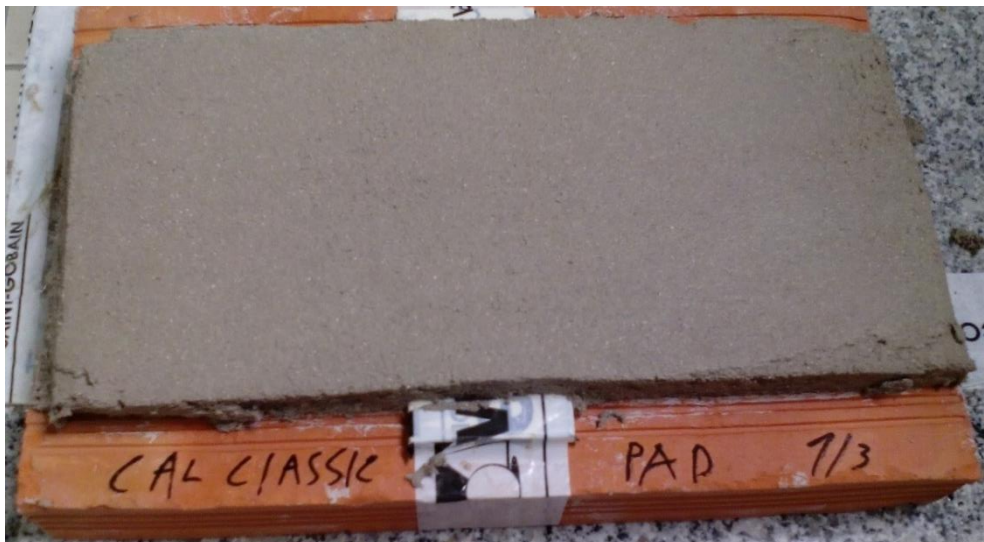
Aplicação de argamassa para o teste de fissuração plástica.
